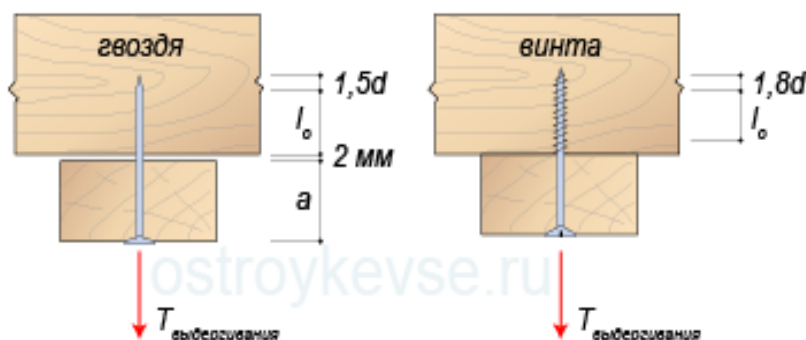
Определение расчетной рабочей длины стального нагеля, работающего на выдергивание
